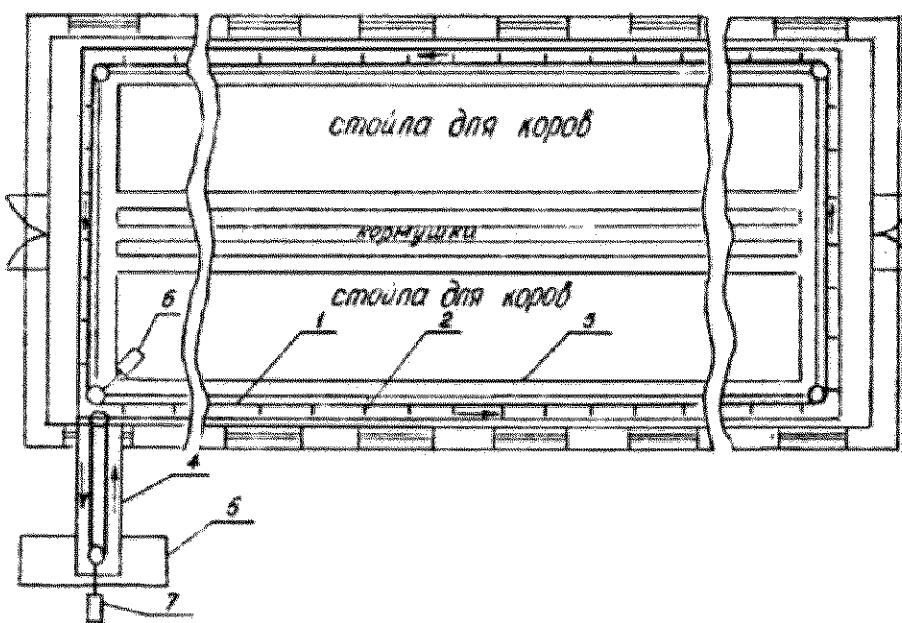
Схема расположения в двухрядном коровнике навозоуборочного транспортера ТЧН–160А:
